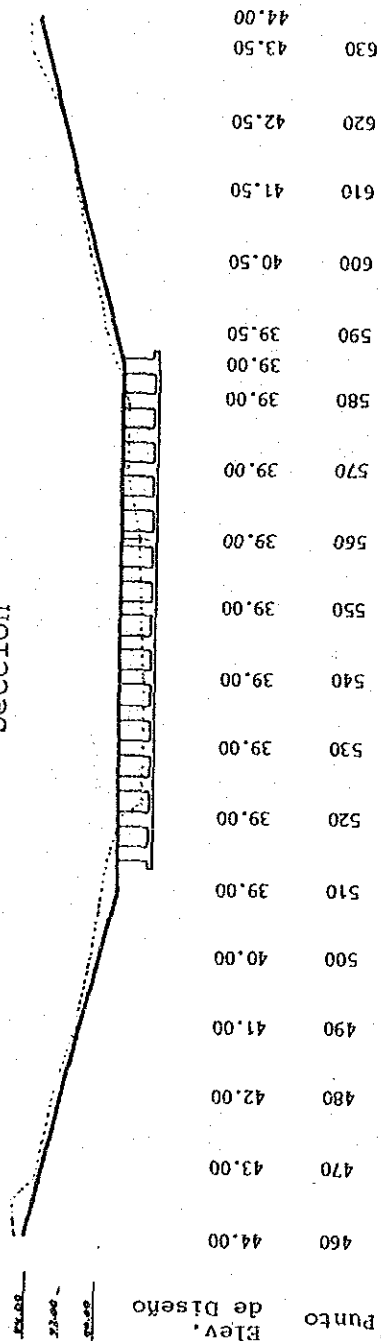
Plan de Puente Inundable (Río Sampile)
